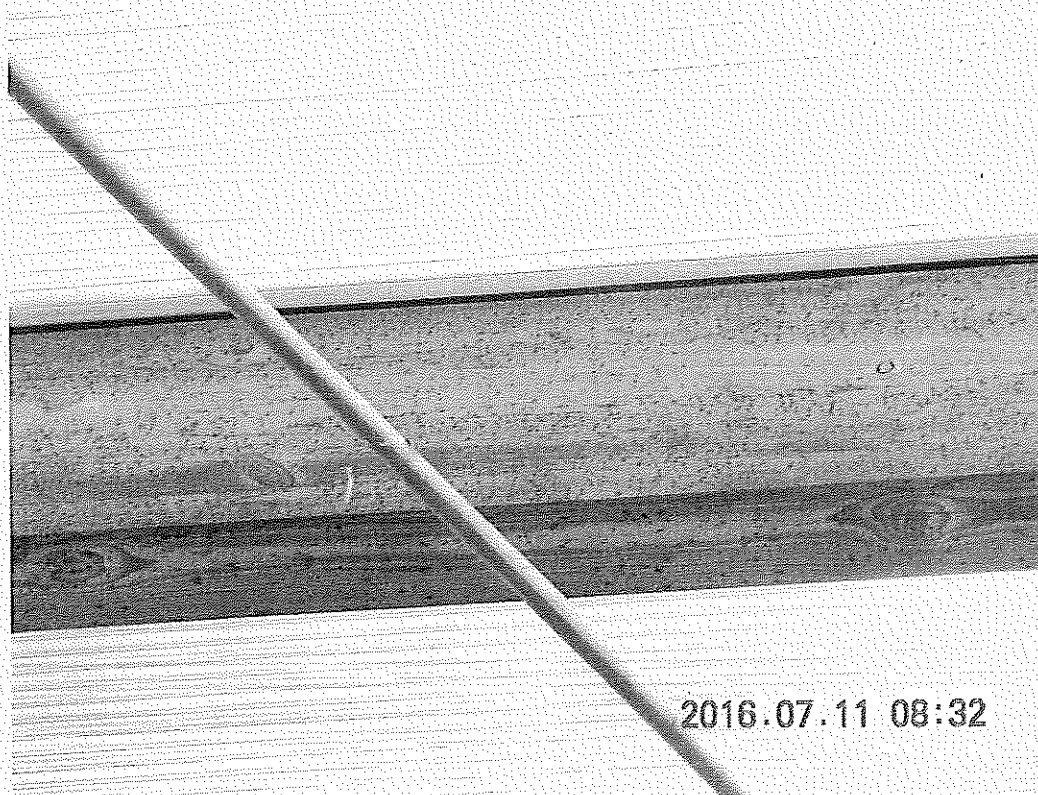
Widok ogólny konstrukcji dachu od strony korony trybuny.
